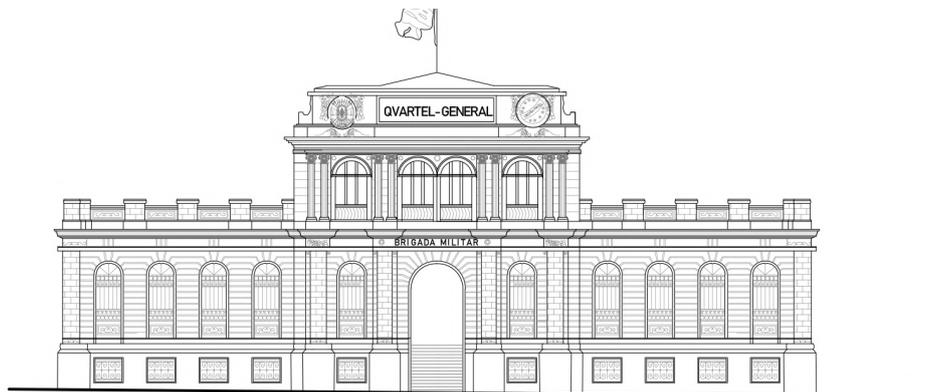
Redesenho da fachada nobre, voltada para a rua dos Andradas.
